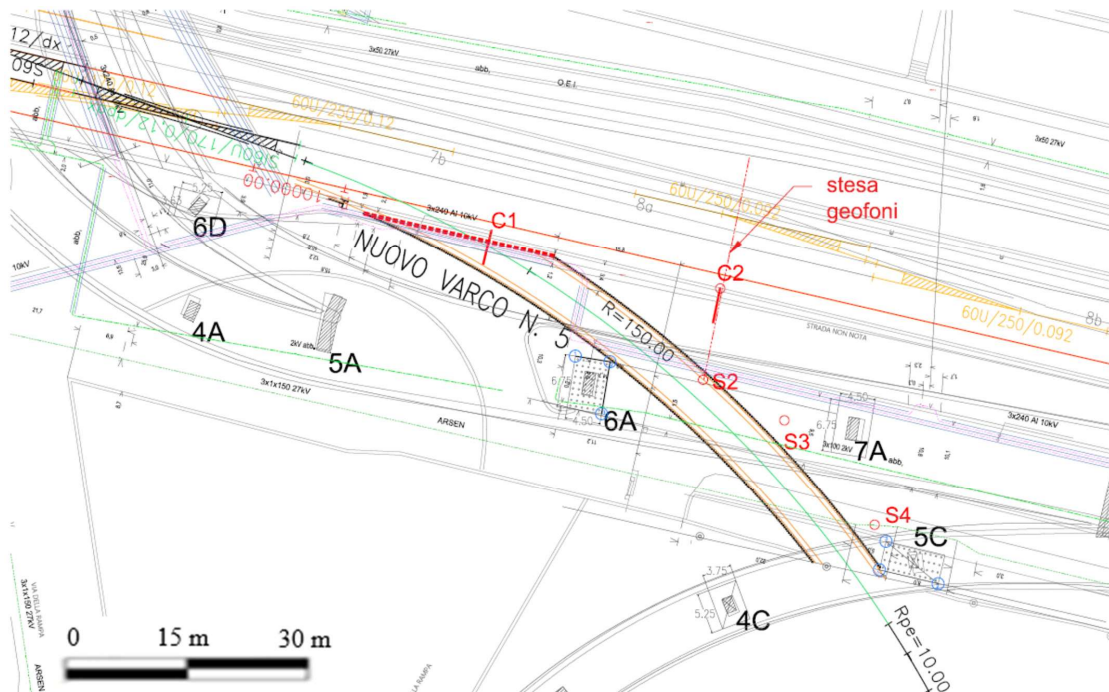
Planimetria con ubicazione delle indagini geognostiche eseguite
